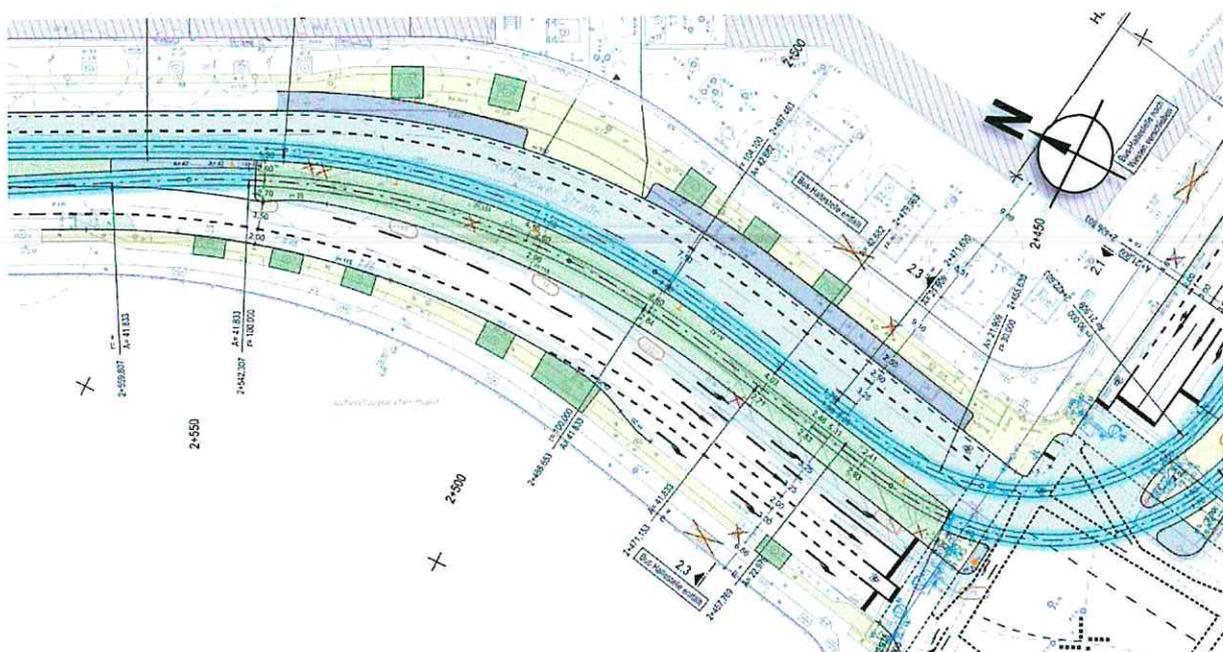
Lageplan Rathenower Straße, Teilabschnitt Süd
